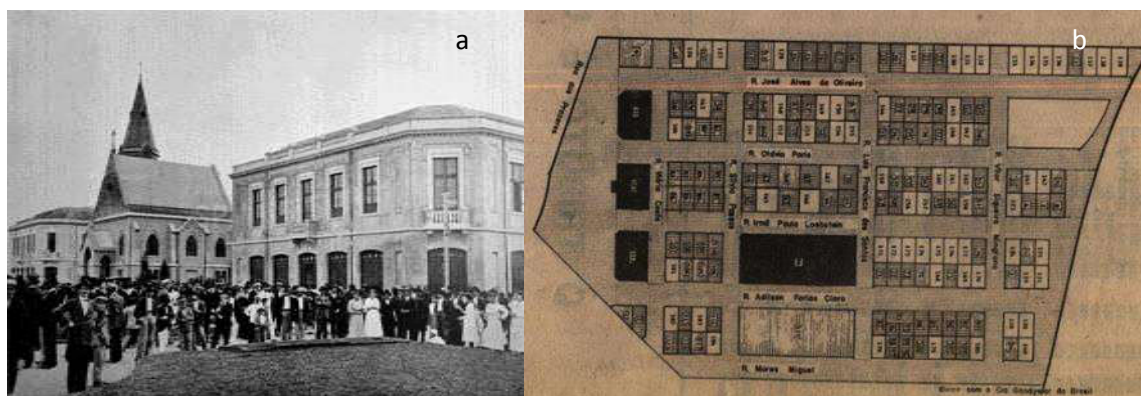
Vila Maria Zélia, 1917: (a) Inauguração. (b) Planta da Vila.
